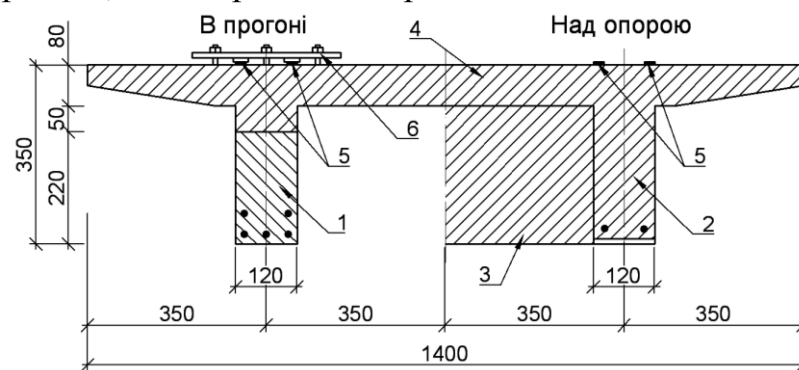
Поперечні перерізи дослідної конструкції: 1 – збірна прогонова балка, 2 – надопорна монолітна балки, 3 – монолітна поперечна балка, 4 – монолітна плита, 5 – надопорна неметалева стрічкова арматура Sika Carbodur S512, 6 - анкерна деталь для кріплення стрічкової надопорної арматури.
